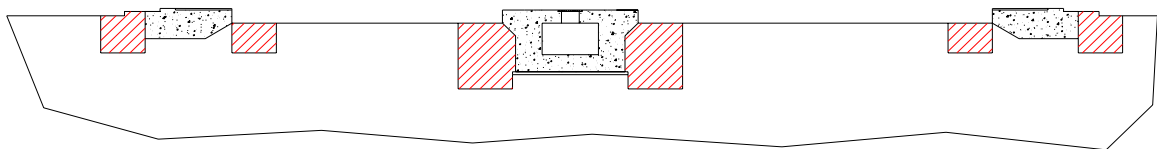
scavo trincee di accesso a sezioni periferiche e struttura centrale fondazione
